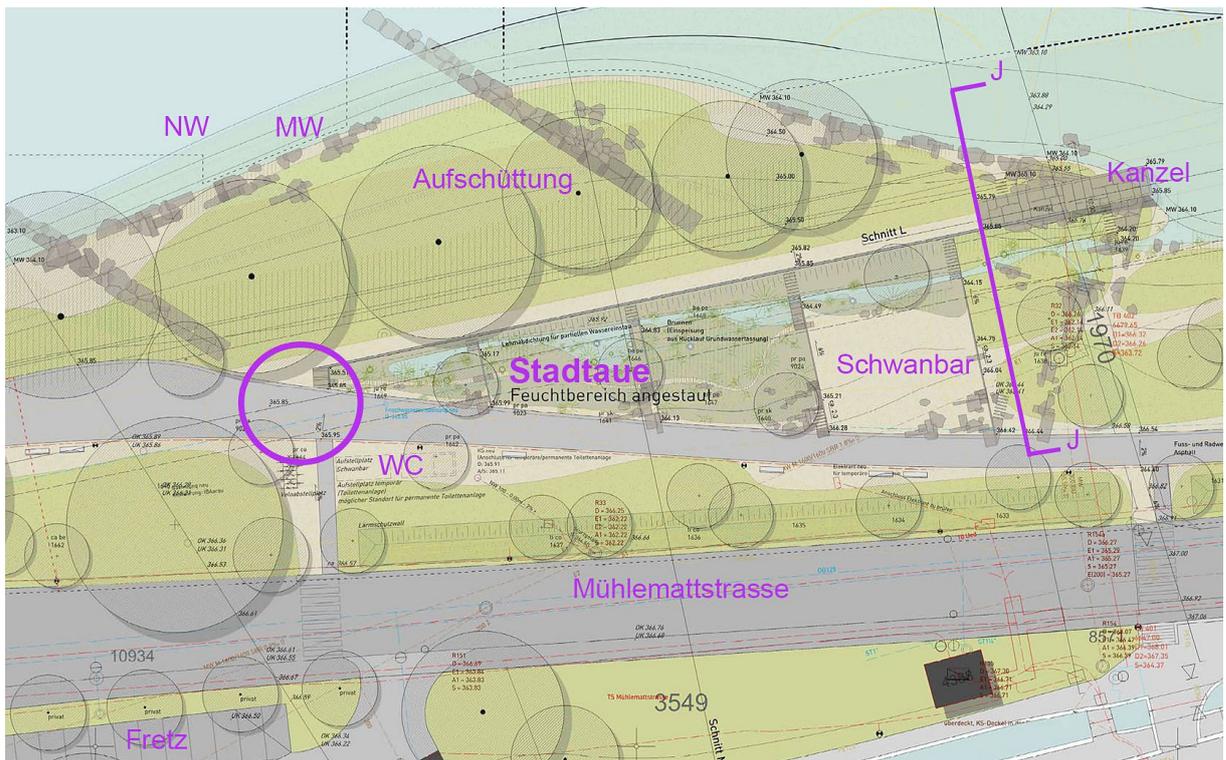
Feuchtgebiet Stadtaue mit Standort Schwanbar und Aufschüttung (Ausschnitt Situation Bauprojekt, im Detail siehe Aktenauflage)
